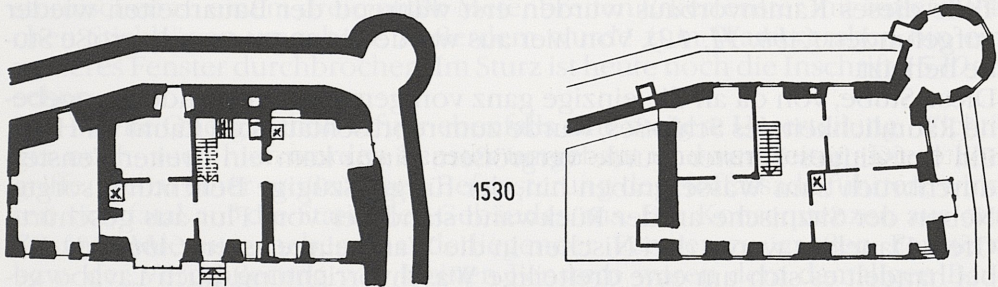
Schloß Dallau. Grundrissdisposition des ersten und zweiten Obergeschosses im Jahre 1530.
